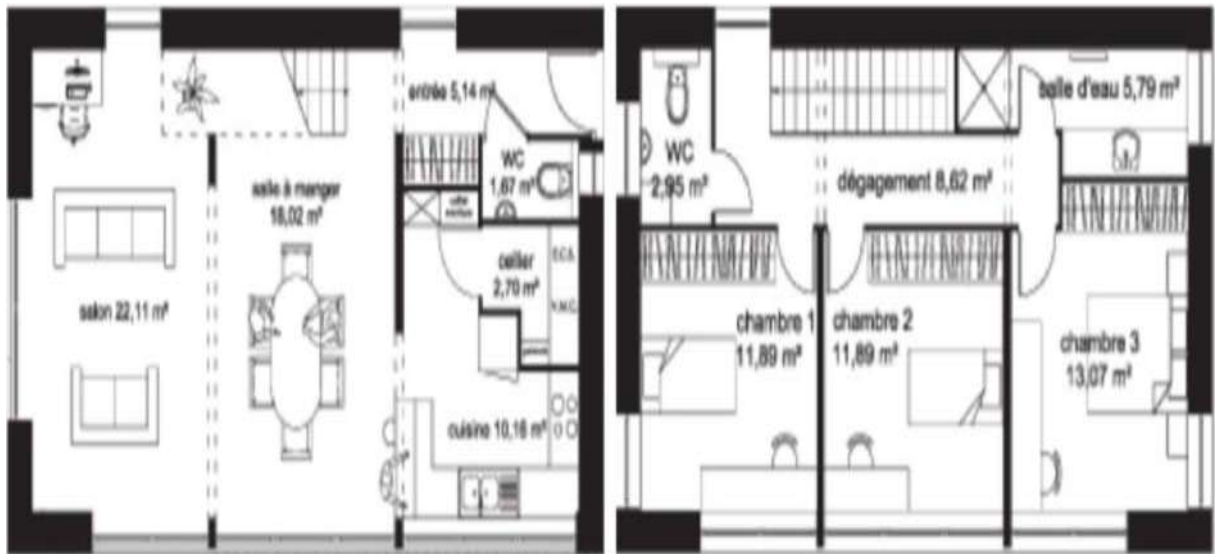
Plan du rez-de-chaussée (à gauche) et de l'étage (à droite) de la maison Chloé
